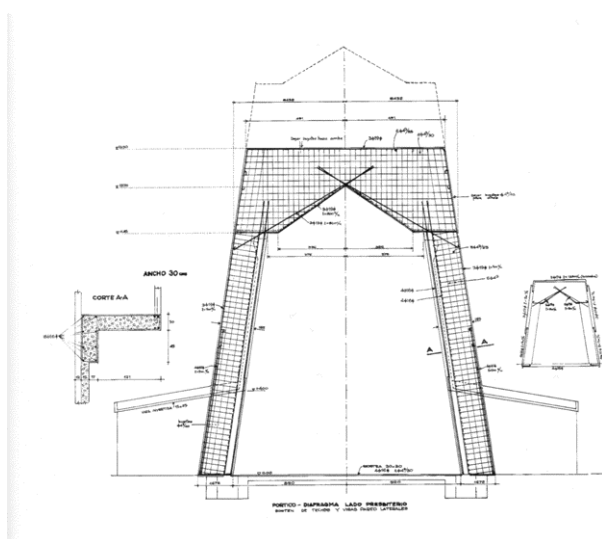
Igreja de São Pedro. Pórtico de concreto armado do santuário.
